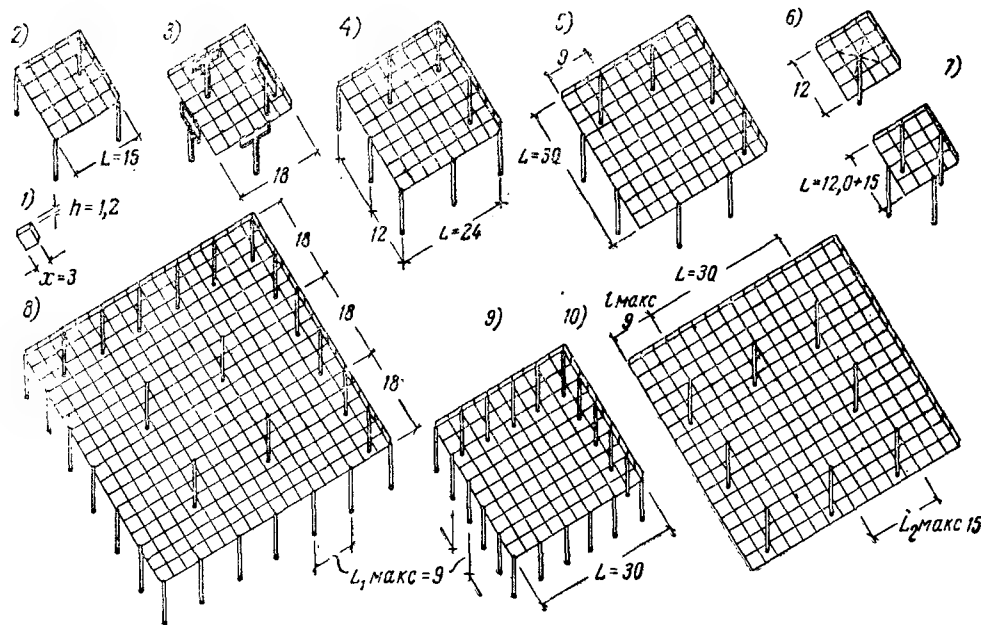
Схемы опирания перекрестных квадратных в плане покрытий
